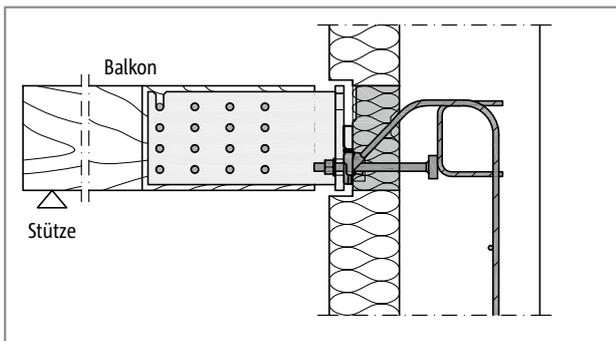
Schöck Isokorb® T Typ SQ mit Stahlschwert: Sonderkonstruktion; erforderlich bei Anschluss an eine Stahlbetonwand
